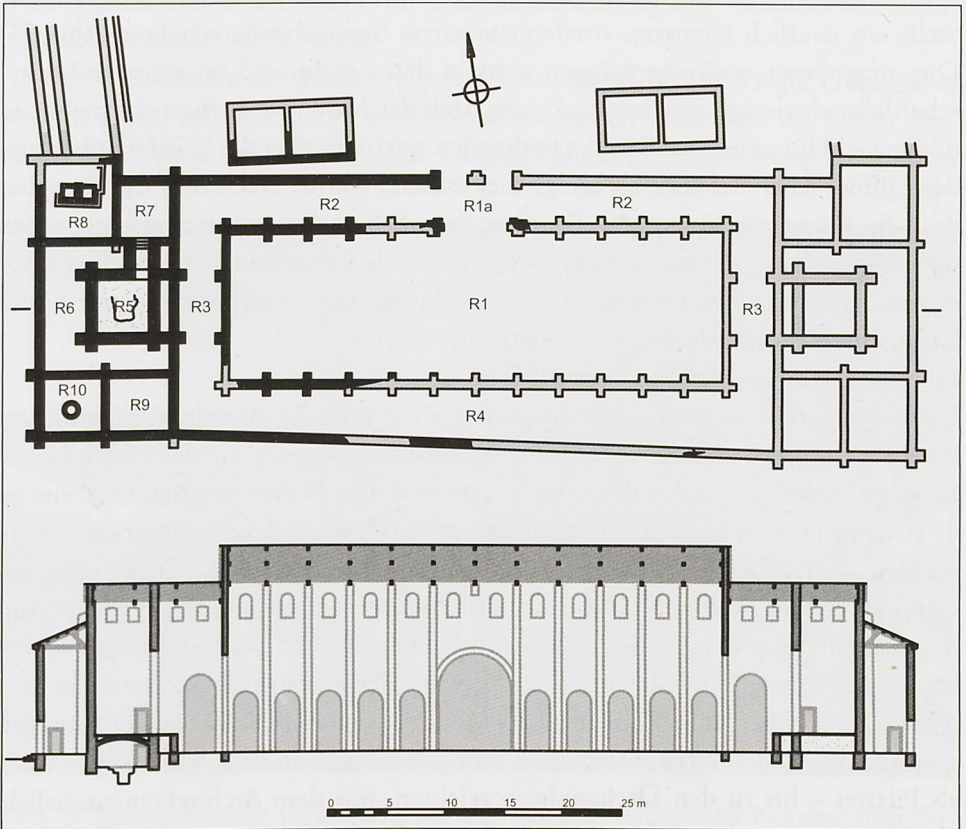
Grundriss (mit Raumbezeichnungen) und rekonstruierter Längsschnitt der Riegeler Forumsbasilika. (Rekonstruktion und Zeichnung: Ch. Dreier).
